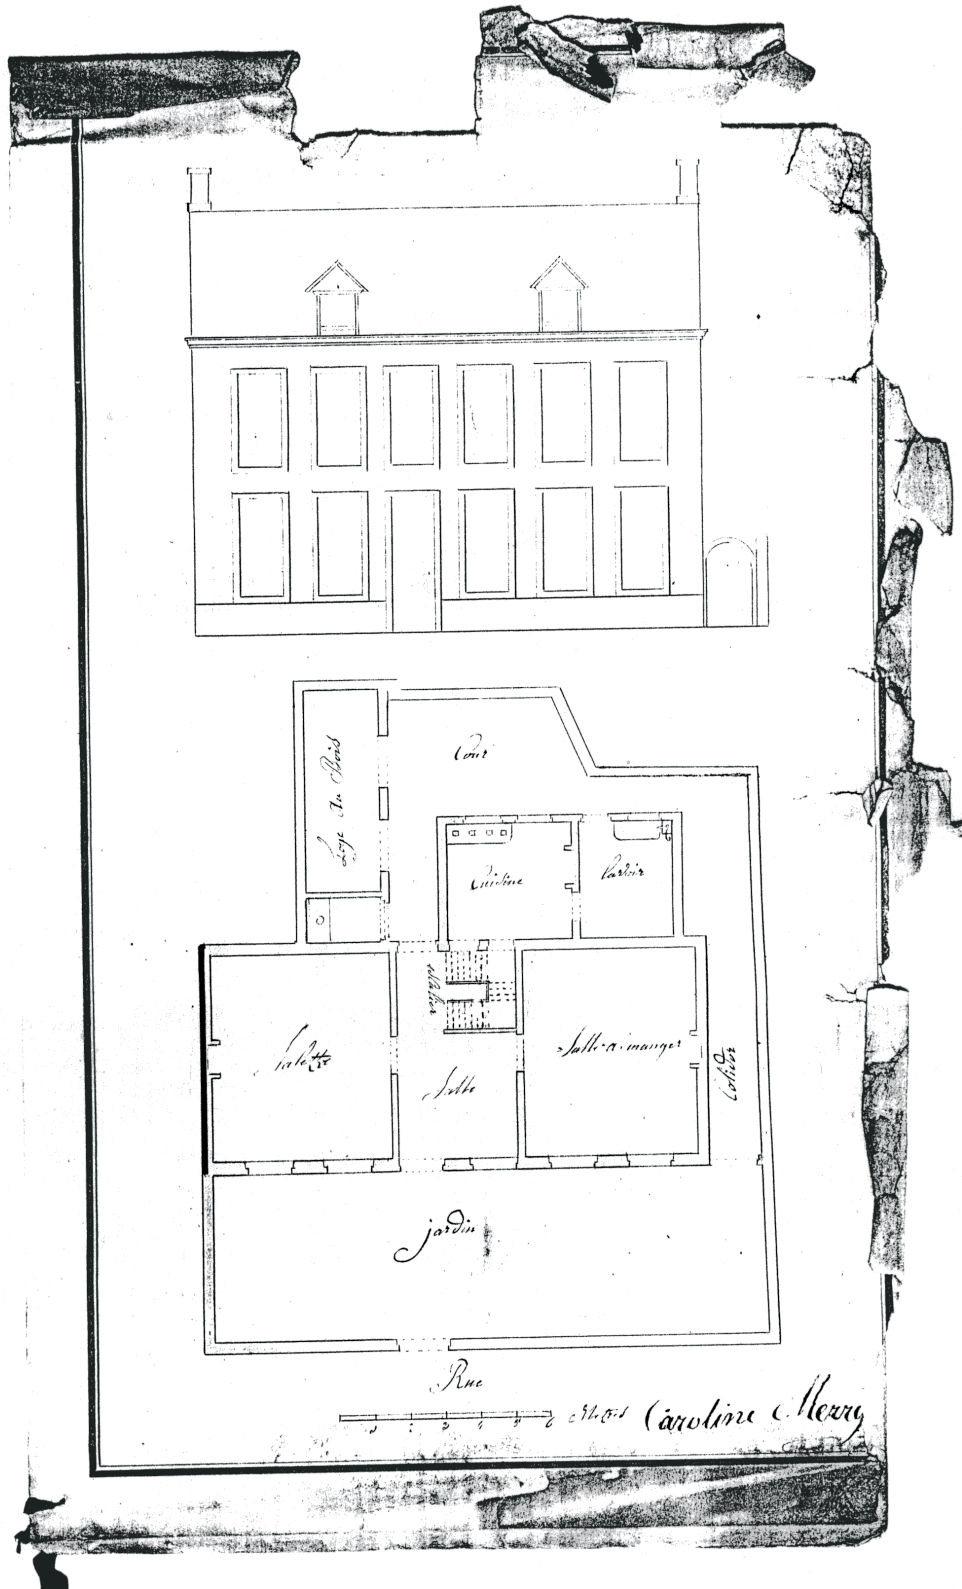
(Gent, K5) Fassade und Grundriss des neu geplanten Hauses von Caroline Merry, Quelle: Rijksarchief Gent, Verzeichnis: Schelde 3791/ 8. Brief vom Dezember 1813 an den Conseil d'état betreffs den Bau eines Wohnhauses.
